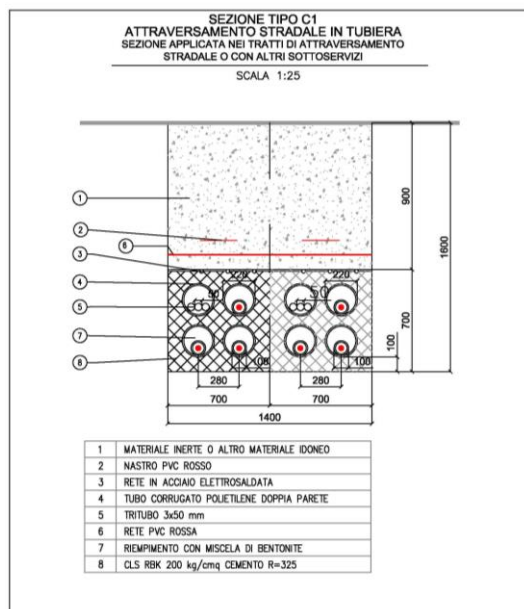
Sezione tipo attraversamento stradale in tubiera
